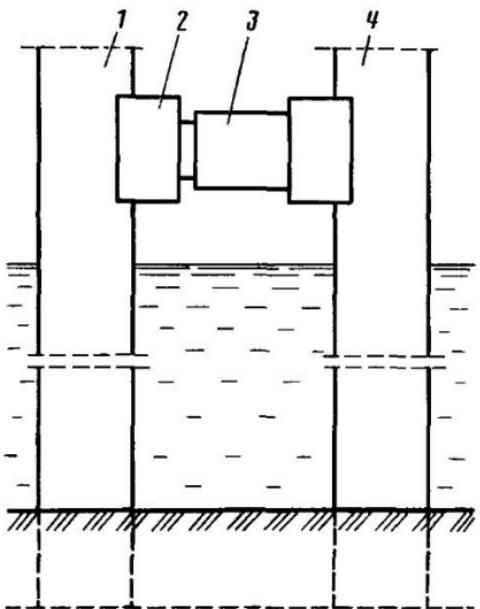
Схема установки домкрата для испытания горизонтальной нагрузкой свайных элементов:
